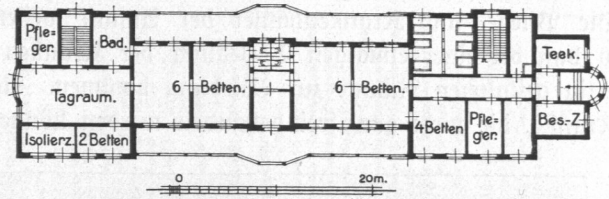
Irrenanstalt Friedrichsberg, Haus für unruhige Männer IV. Klasse, Erdgesch. Grundriß.
